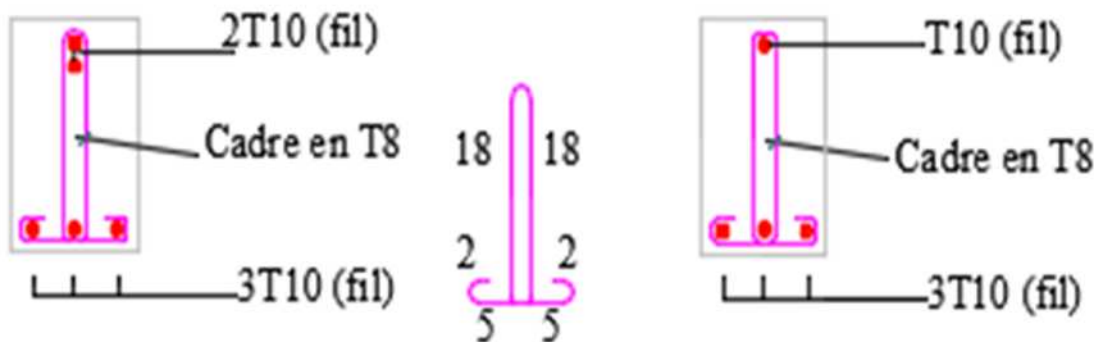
Plan de ferrailage de la poutrelle au niveau des appuis et travée
